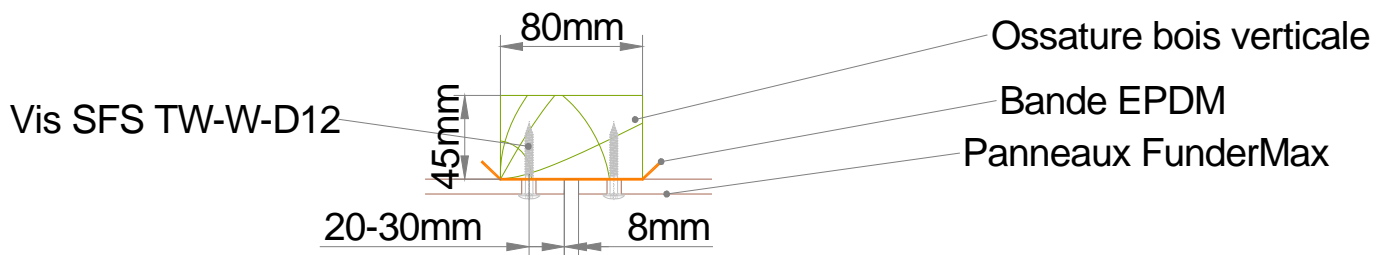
Joint vertical à la jonction de panneaux en bardage rapporté ventilé
